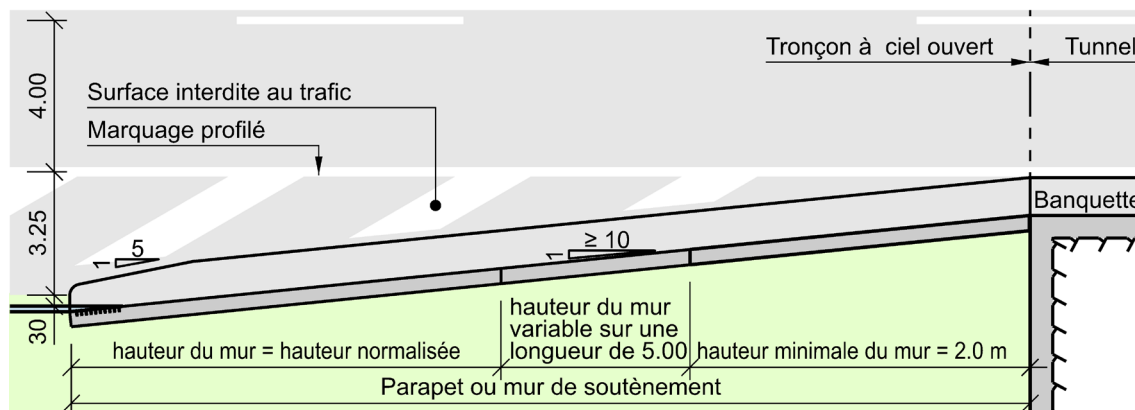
Variante 4 – Parapet ou mur de soutènement dirigé vers le tunnel, sans abaissement de la banquette
